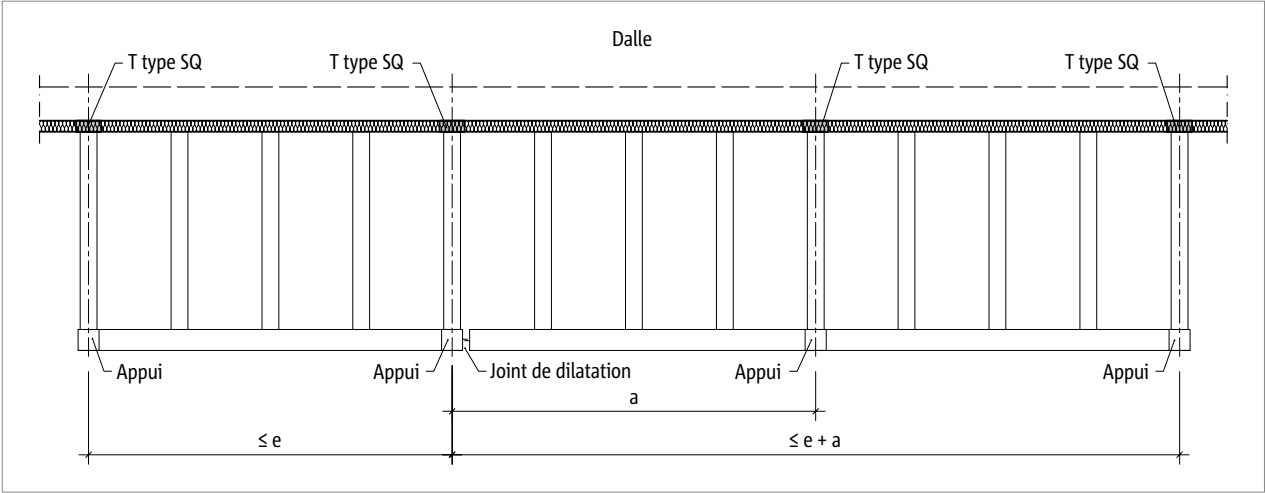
Schöck Isokorb® T type SQ : distance maximale entre joints de dilatation e et débord latéral a
